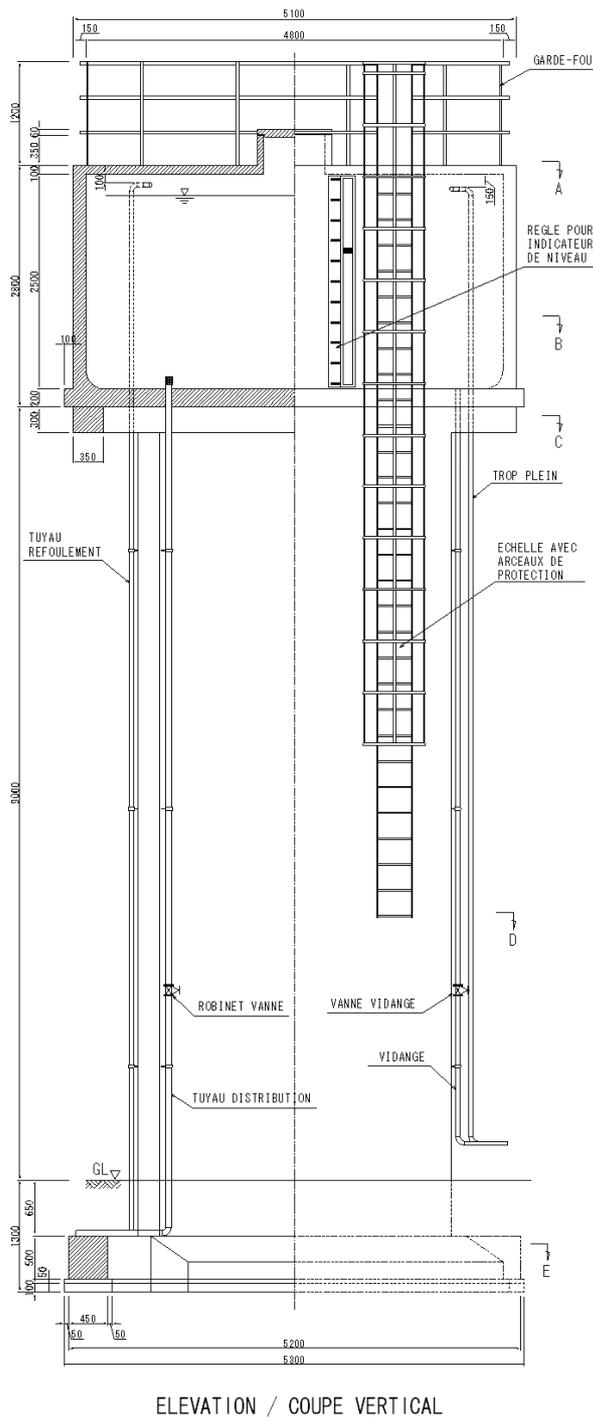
Plan structural standard de château d'eau (40 m<sup>3</sup>, H = 9 m)
